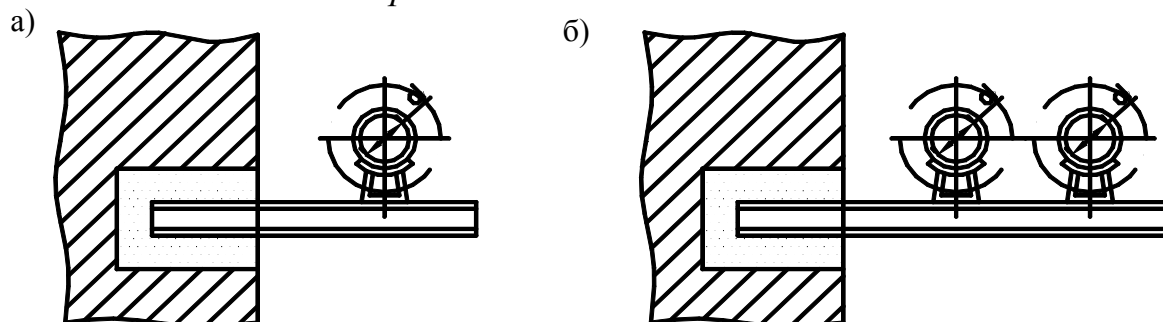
Прокладка трубопроводов на кронштейнах:
